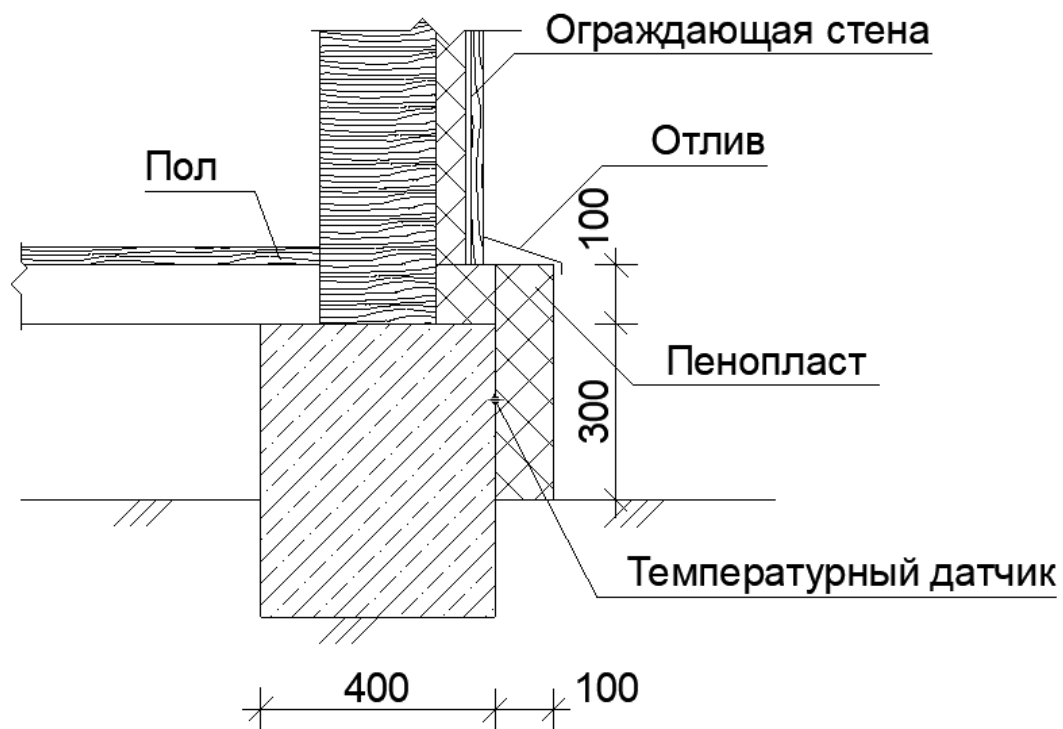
Узел утепления стены технического подвала жилого здания
